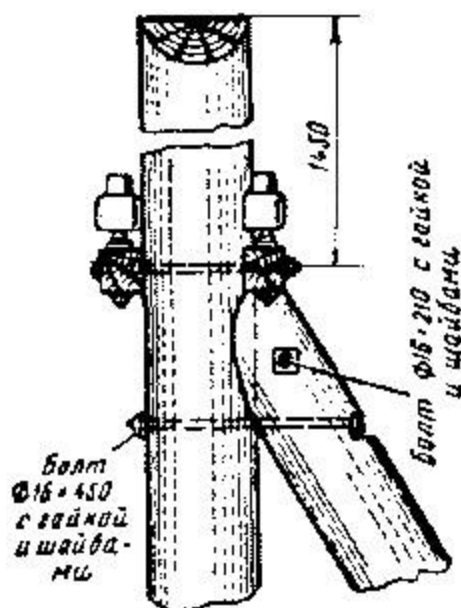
Крепление верхней части подпоры к железобетонной опоре.
